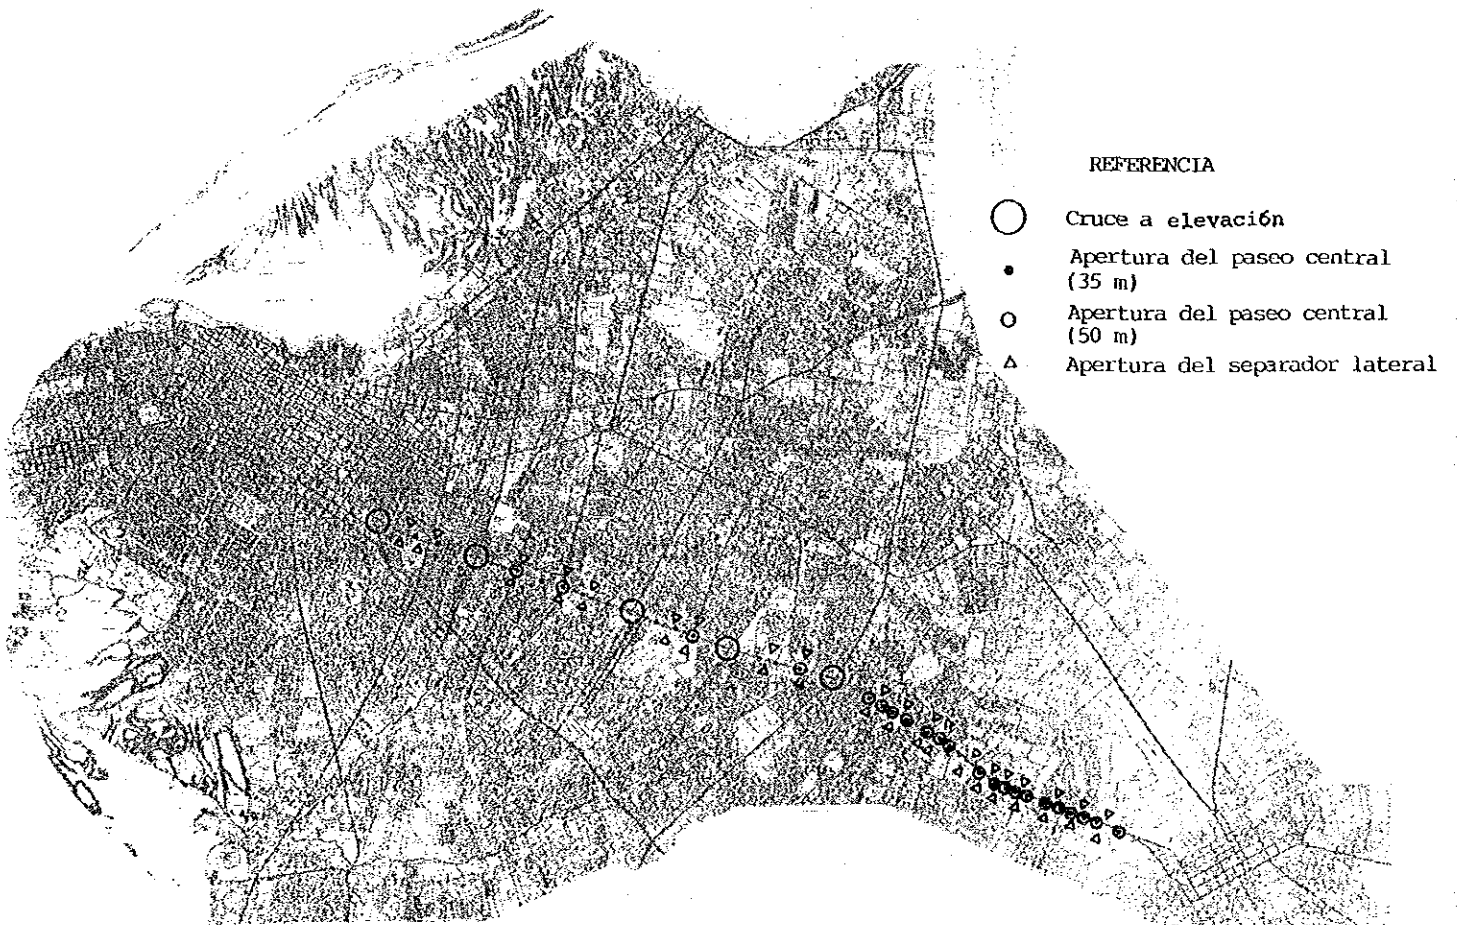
PLANO DE LOCALIZACION DE LAS APERTURAS DEL PASEO CENTRAL
